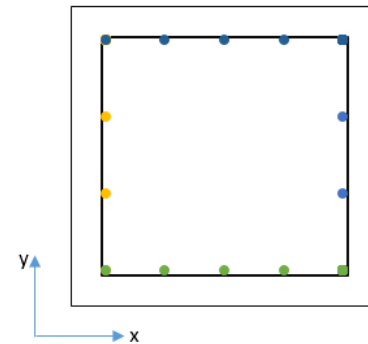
Comprobación de la cuantía en la columna tipo C-2 de sección 0.95 m*0.95 m
